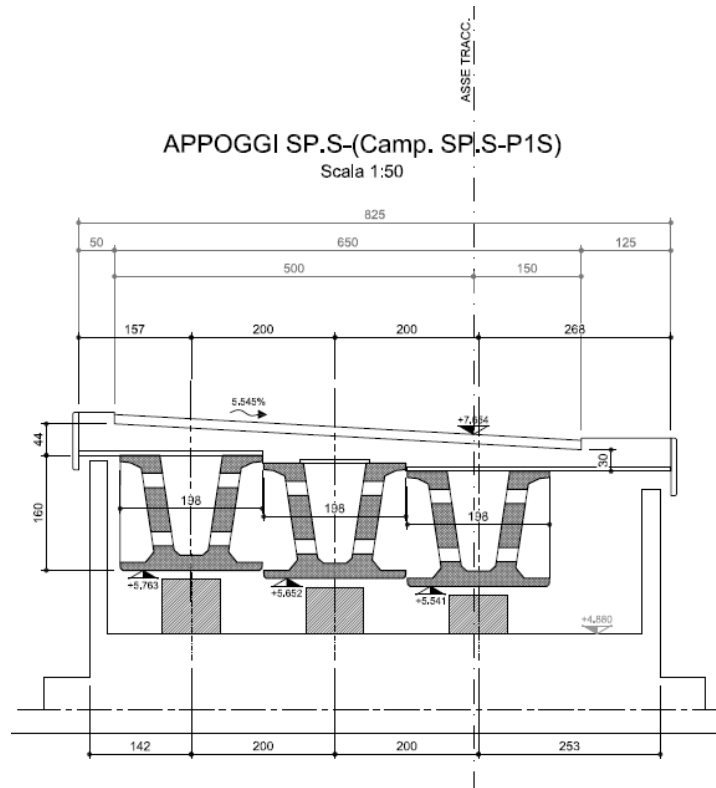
Sezione trasversale Campata 1 (a 3 travi) – Rampa S – SP_S
